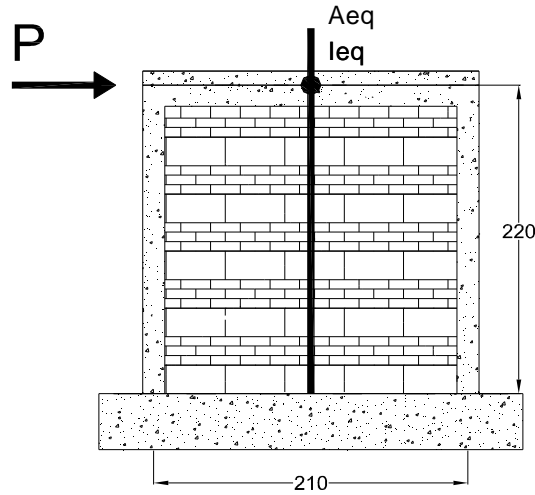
Modelado de muro MCC-3 como columna ancha
